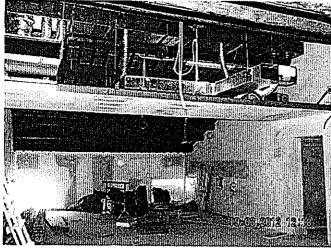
Stanza 2.1: Salone centrale- vista tetto e impianti meccanici
